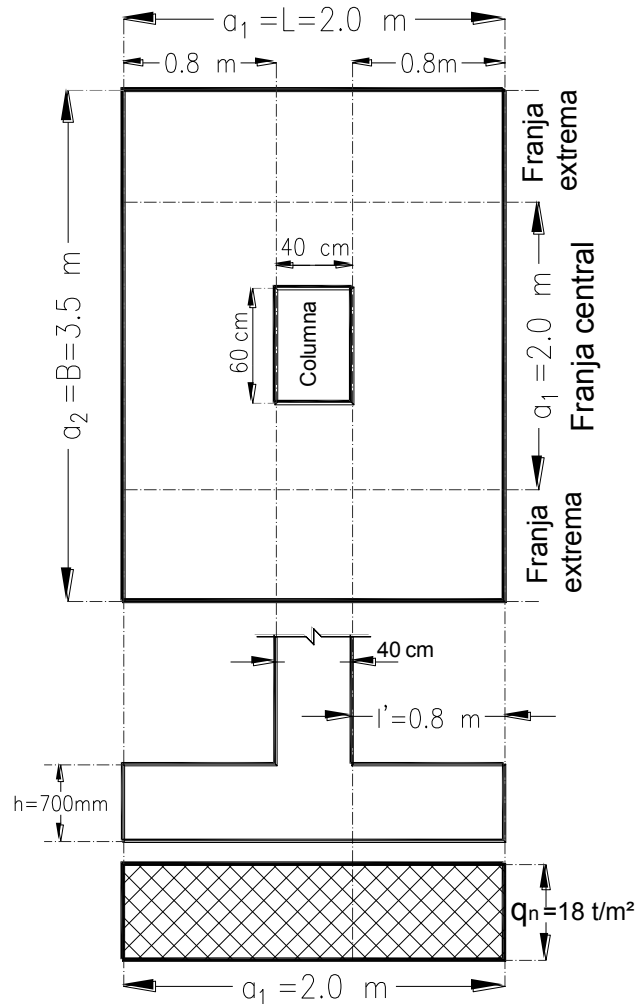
Distribución de franjas paralelas al lado menor de la zapata.
